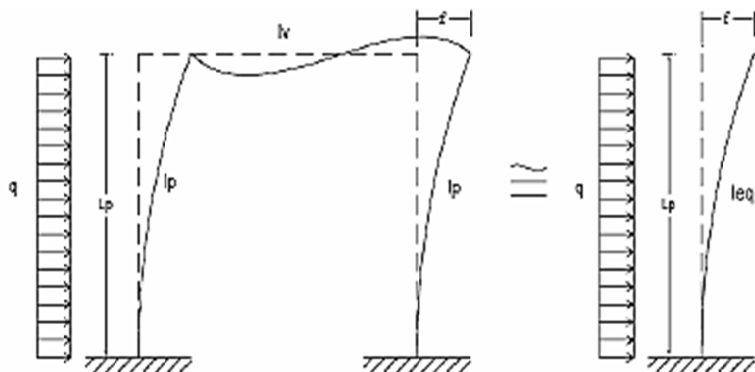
Pilar equivalente proposto por Mário Franco, retirado de BUENO (2009).
